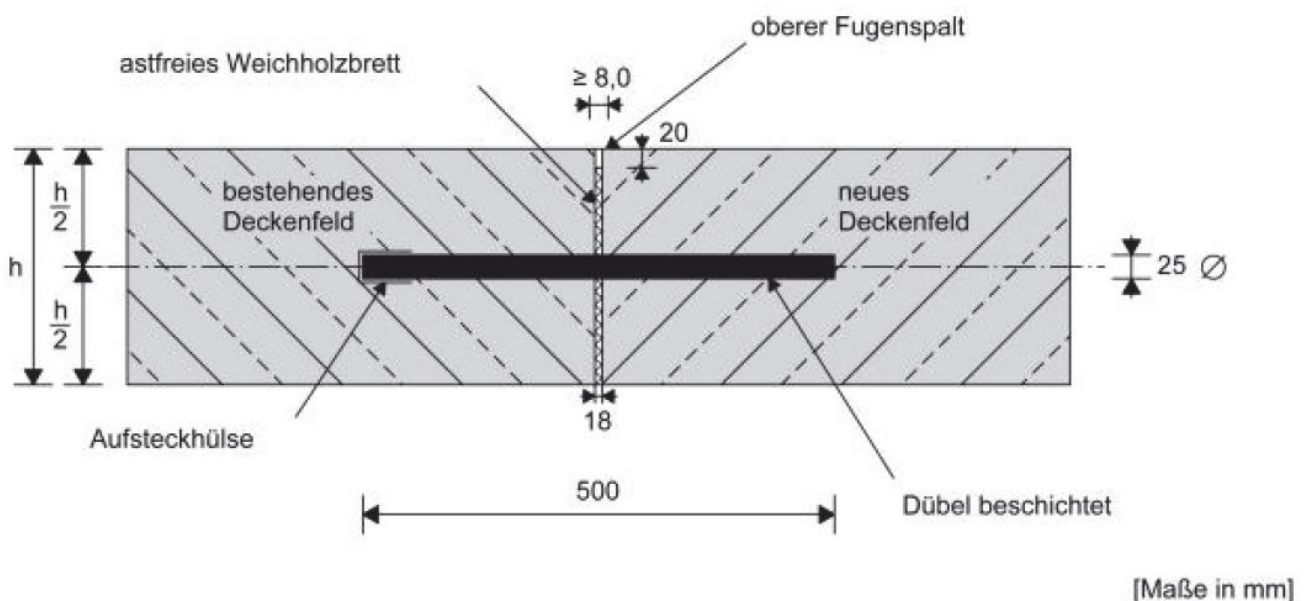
Betondecke unbewehrt mit Raumfuge [1]
